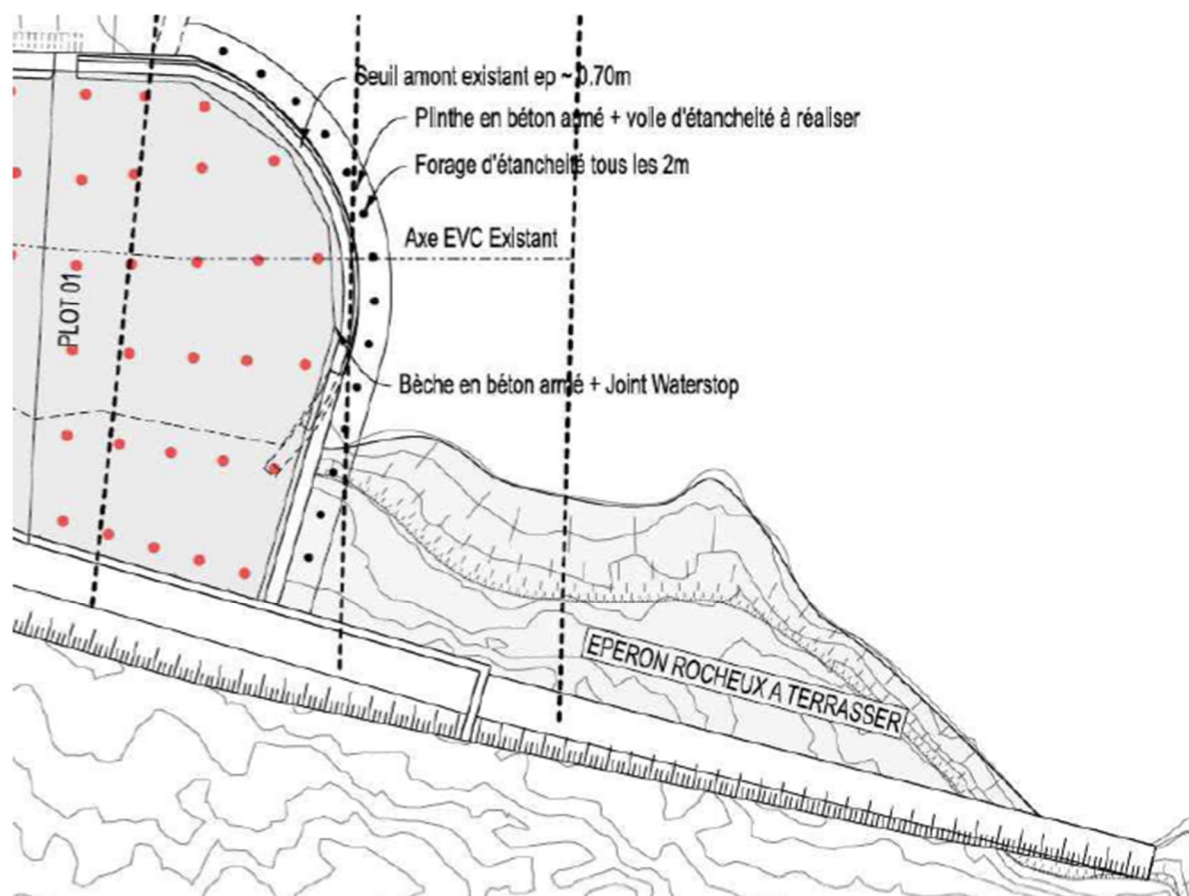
Extension du seuil vers la rive gauche (source : CETA)
